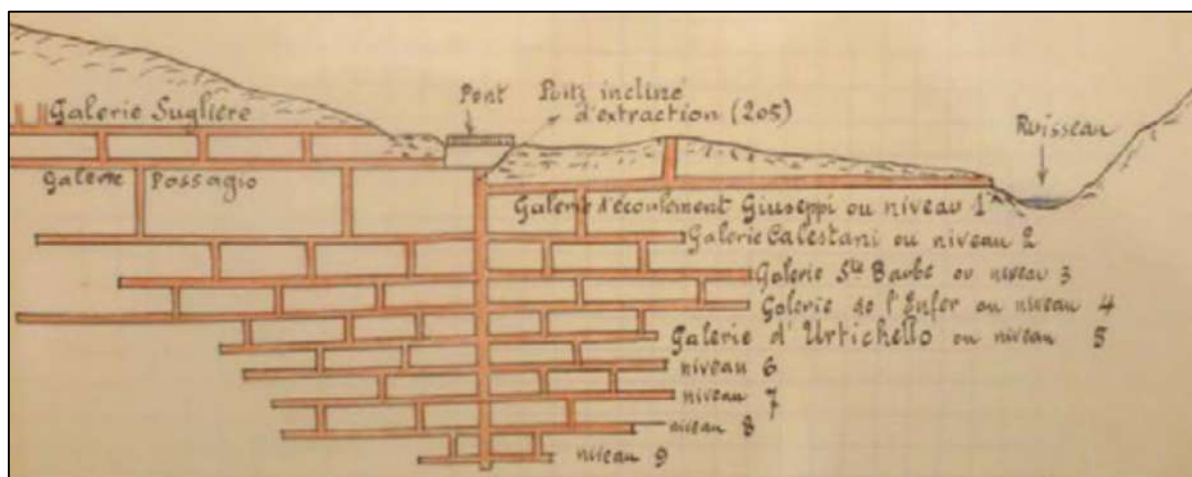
Coupe des travaux du secteur de Castello (Luri)
